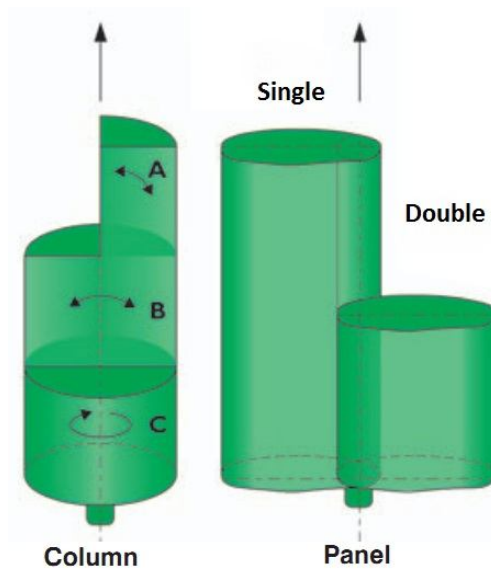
Diferentes geometrias das colunas de *jet-grouting* [7]
